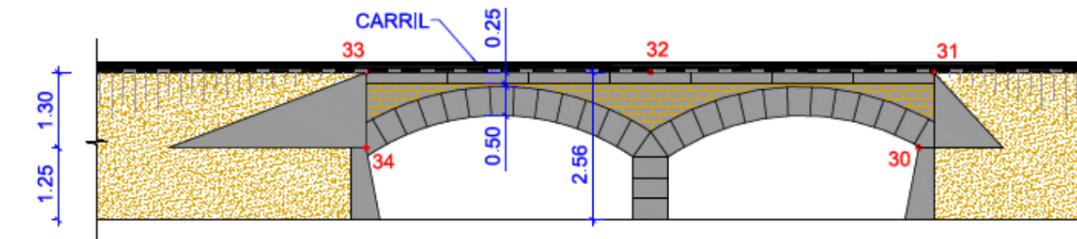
Croquis de la obra de paso del arroyo de la Portiña bajo el actual ferrocarril.
